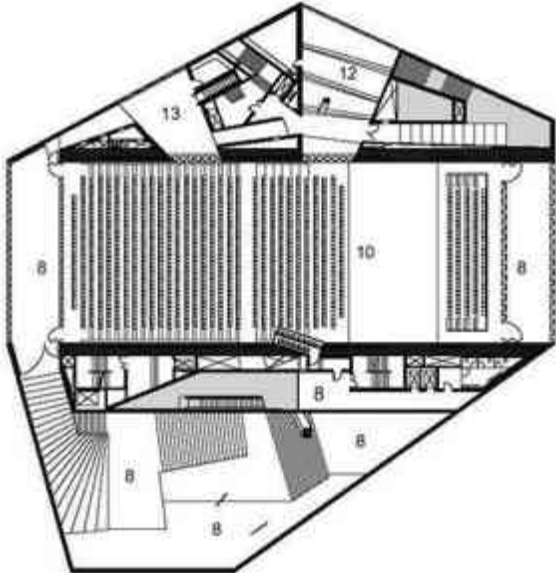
Planta arquitectónica del cuarto nivel del edificio
